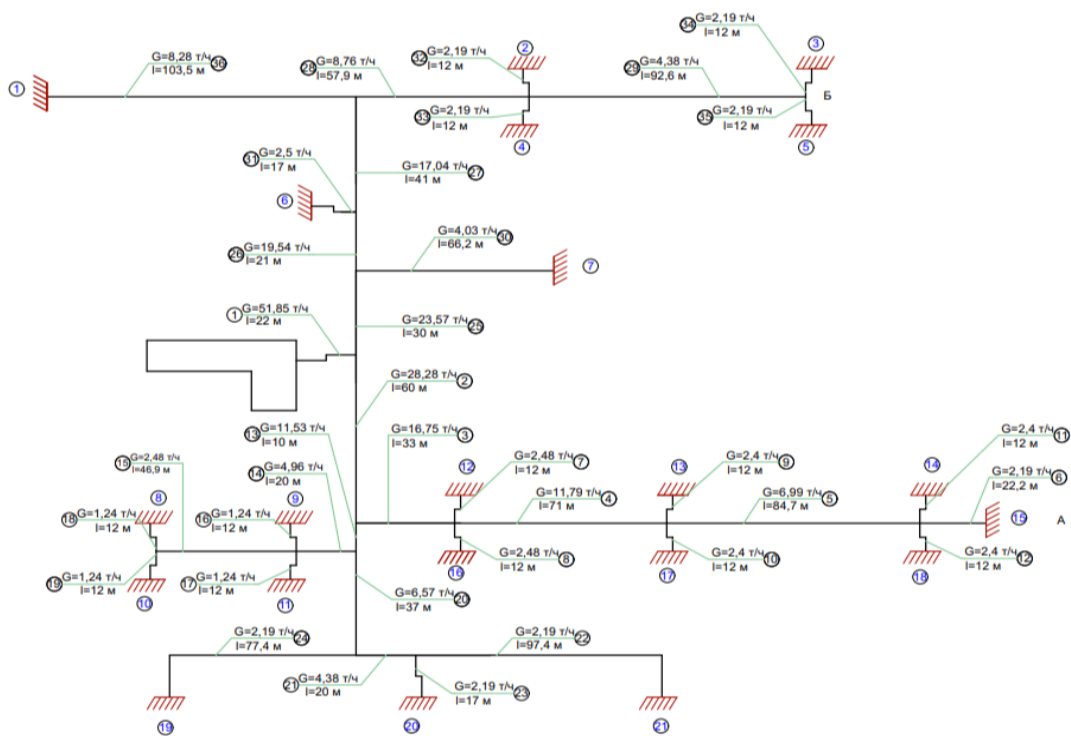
Расчетная схема тепловой сети для теплого периода
